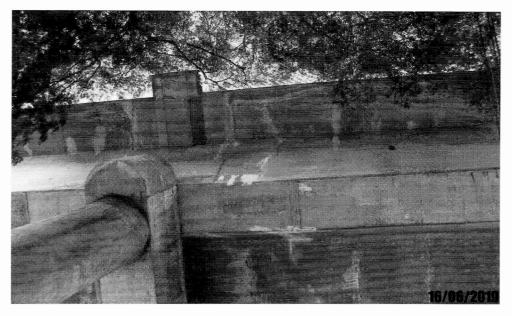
Detalhe da face inferior da viga e do tabuleiro com armadura exposta, eflorescência e desplacamento de concreto.
